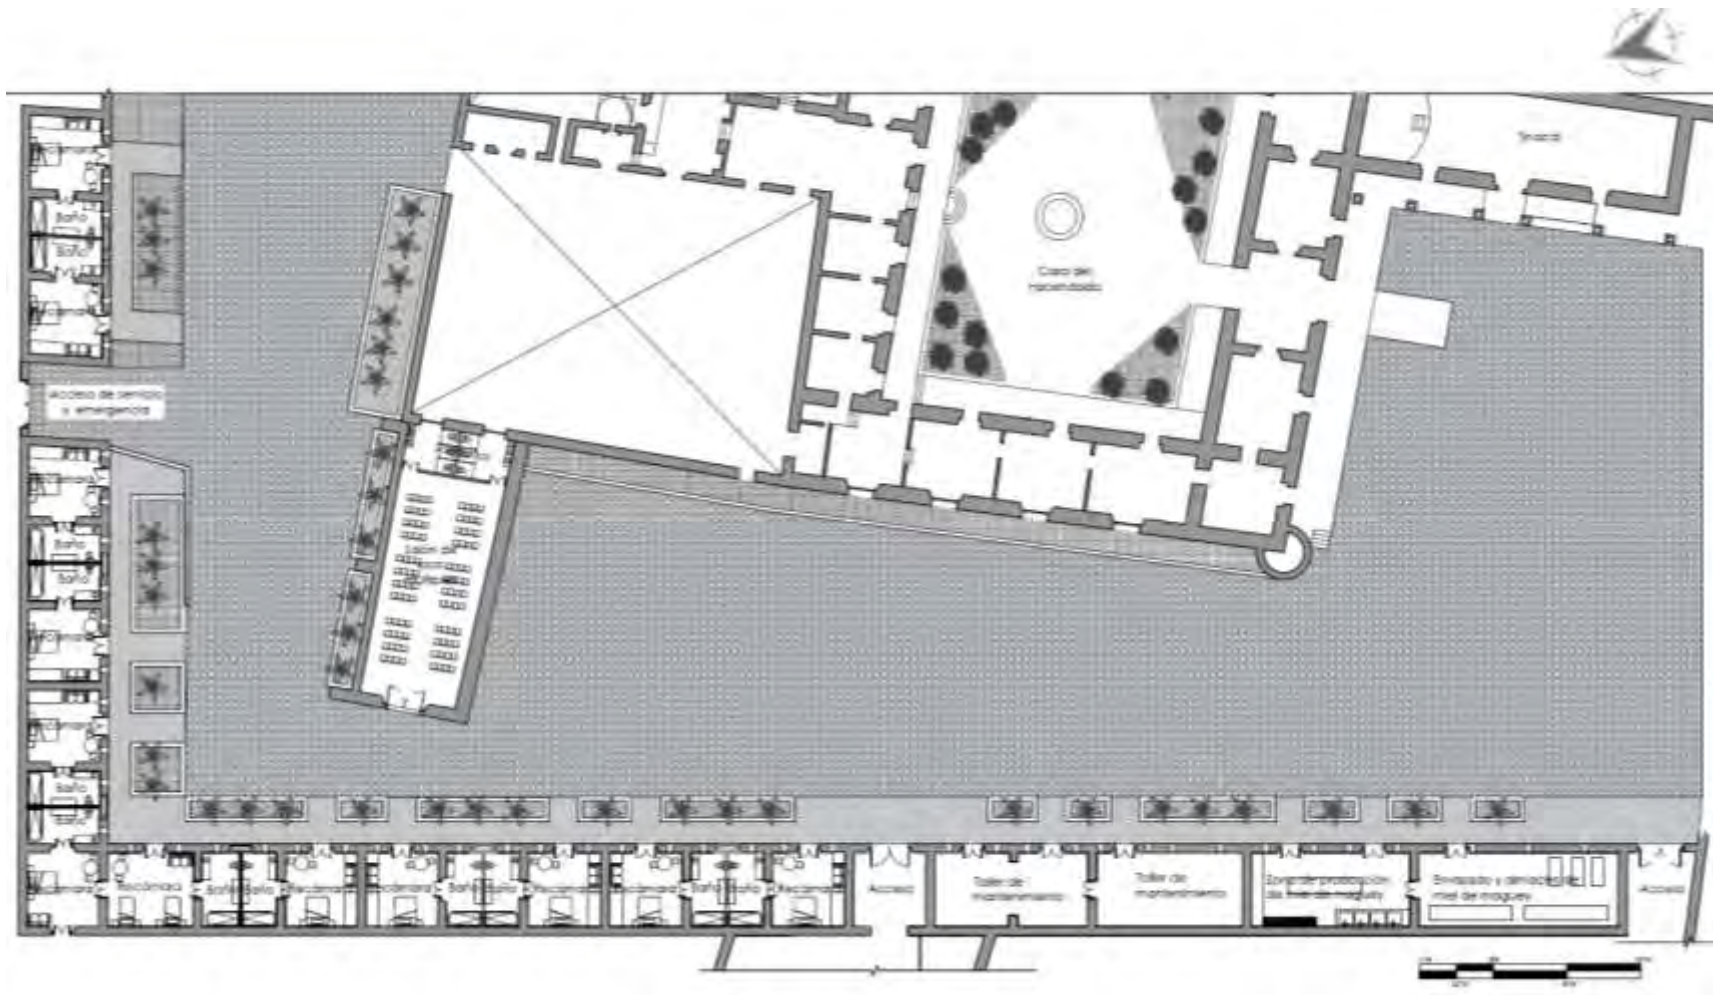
Planta de nuevo uso Calpanerías y Almacén de Carbón.
